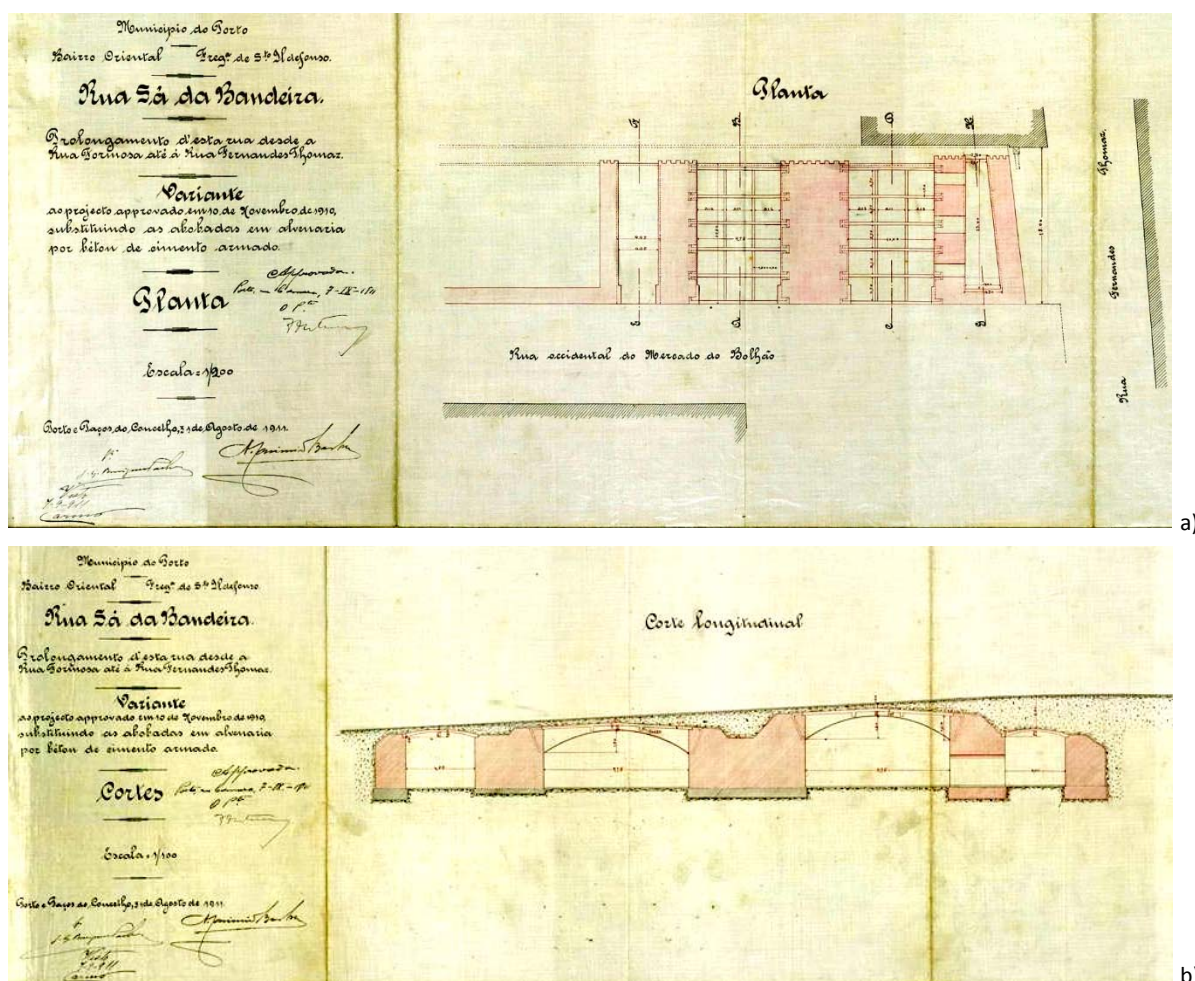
Projeto do criptopórtico da R. de Sá da Bandeira. a) planta e b) corte longitudinal (Ferreira, 2013)
